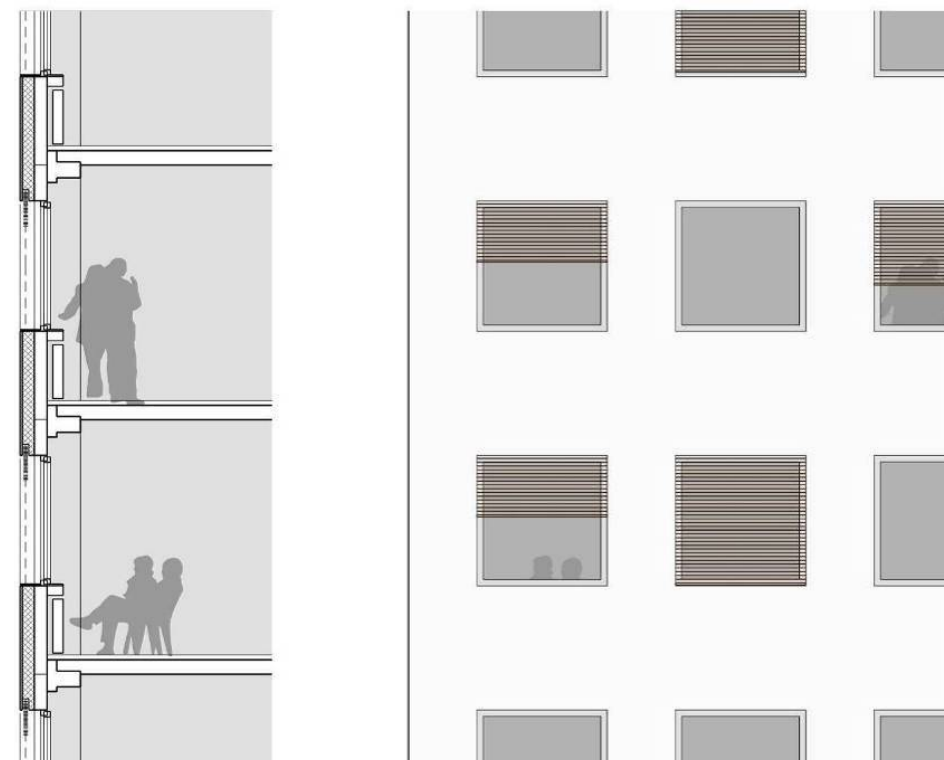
Fassadenvariante 01 - Schnitt / Ansicht
